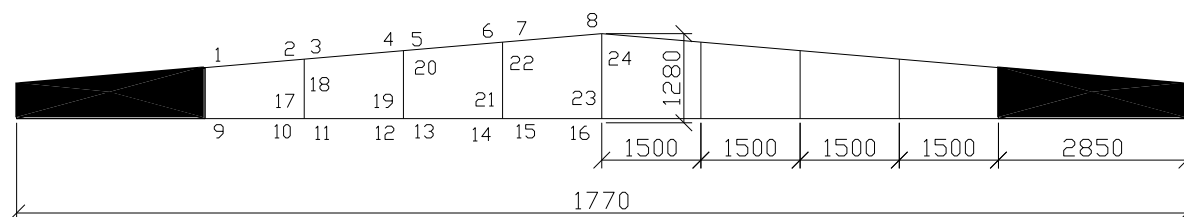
Геометрическая схема и расчетные сечения балки покрытия БДР – 18
